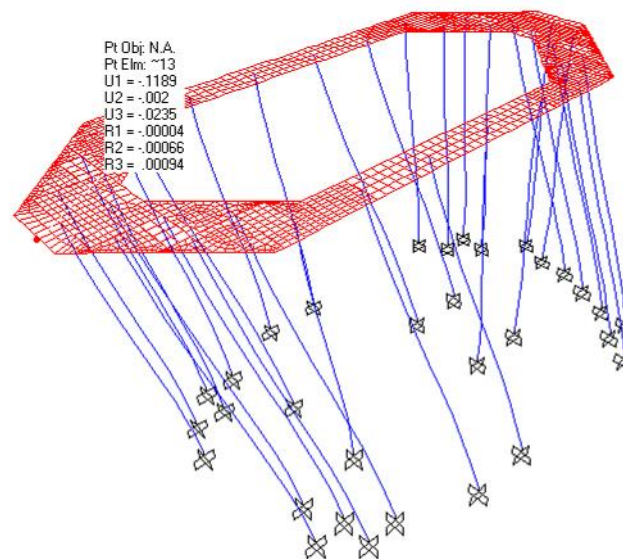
Model struktur bangunan pelindung pilar
